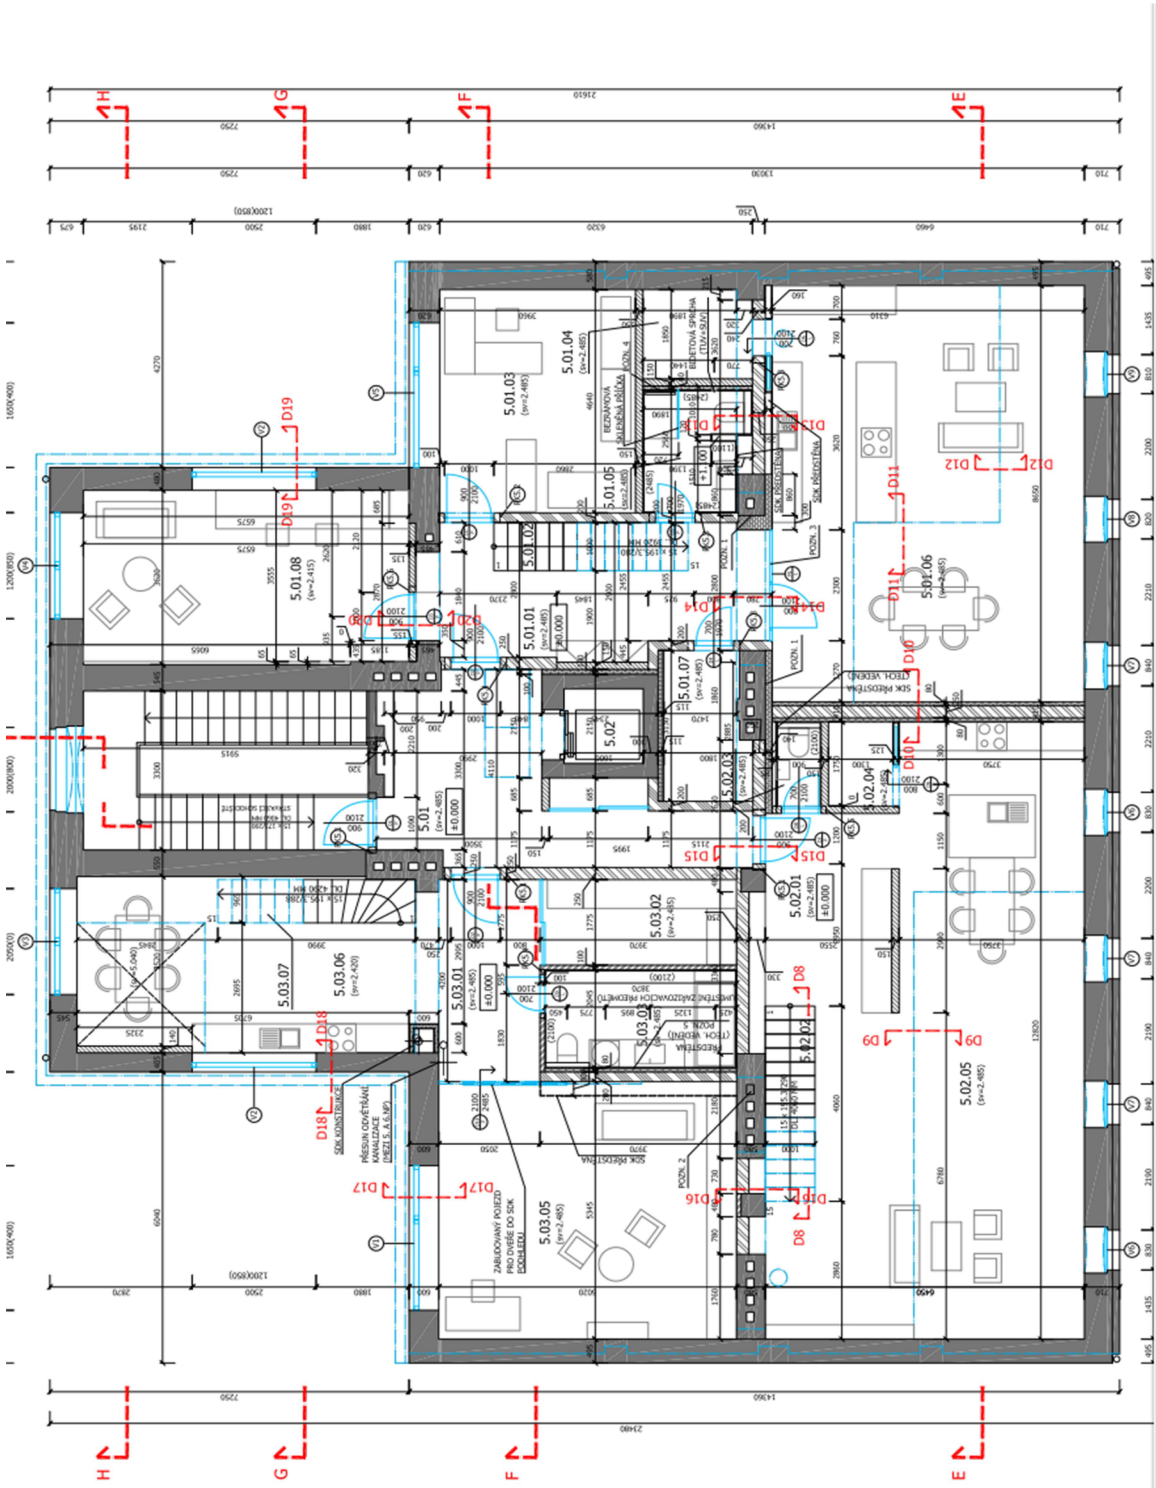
Půdorys 5.NP-půda - Obilní trh 4, stávající stav [PD ing. arch. Lacina]
